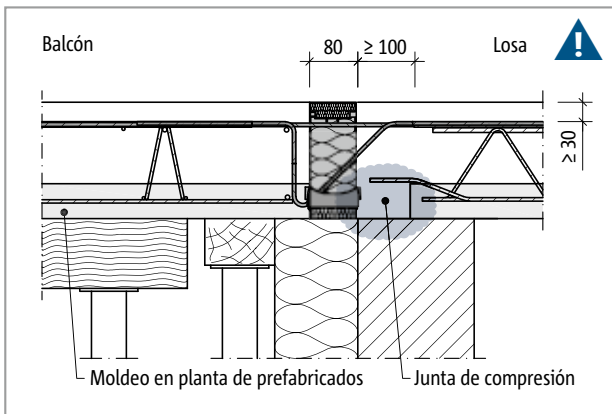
Schöck Isokorb® T tipo K/K-F: apoyo directo, instalación conjunta con placas prefabricadas (aquí:  $h \leq 170$  mm), junta de compresión del lado de la losa
